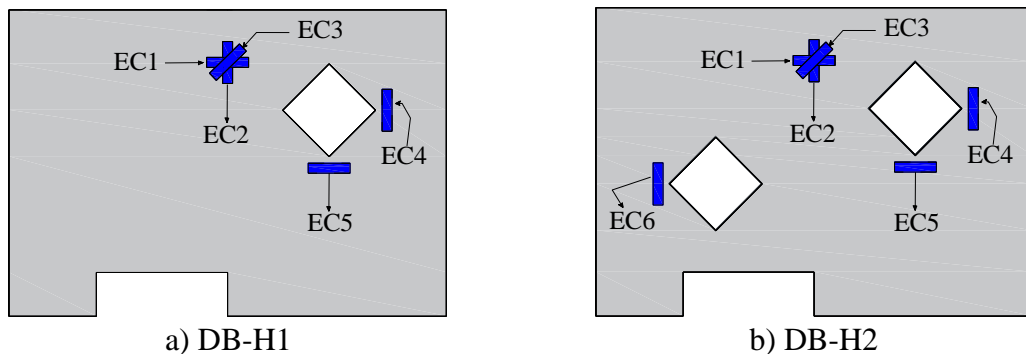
Posição dos extensômetros no concreto das vigas-parede sem reforço
